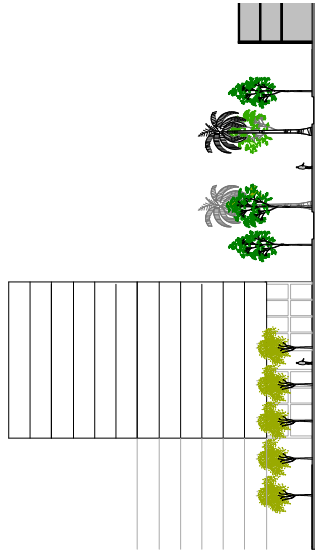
Sección transversal A-A, Rambla Poblenou. Fuente: elaboración propia.
